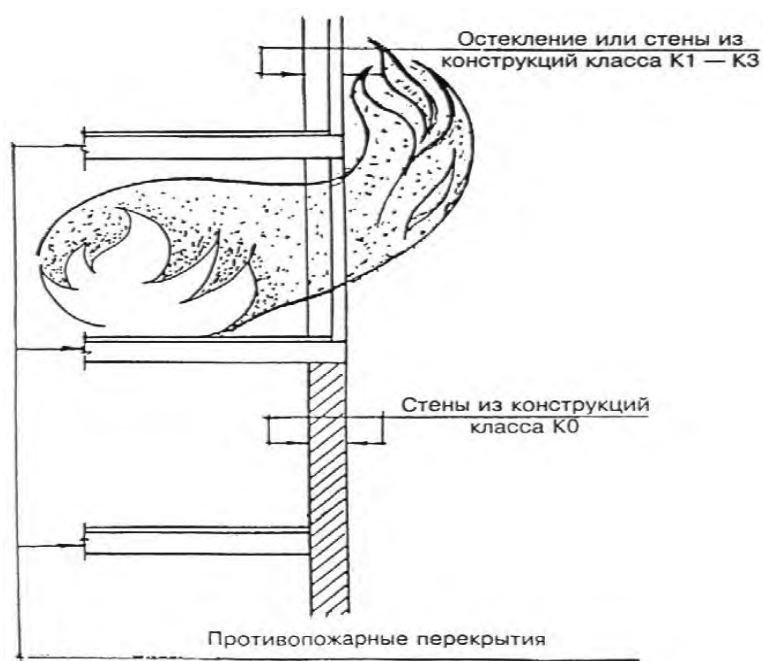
Примыкание противопожарного перекрытия к наружной стене
